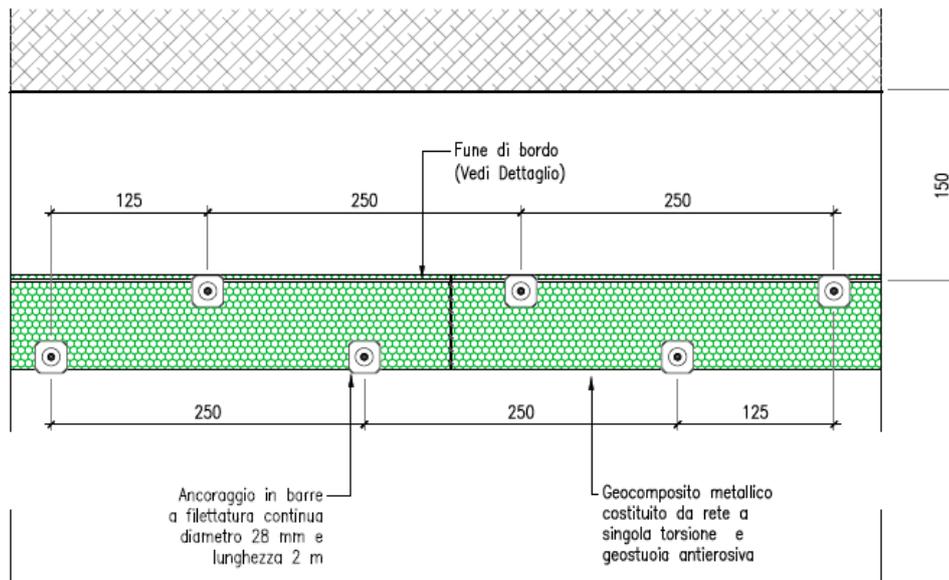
Sezione longitudinale tipologica d'intervento tipo B
